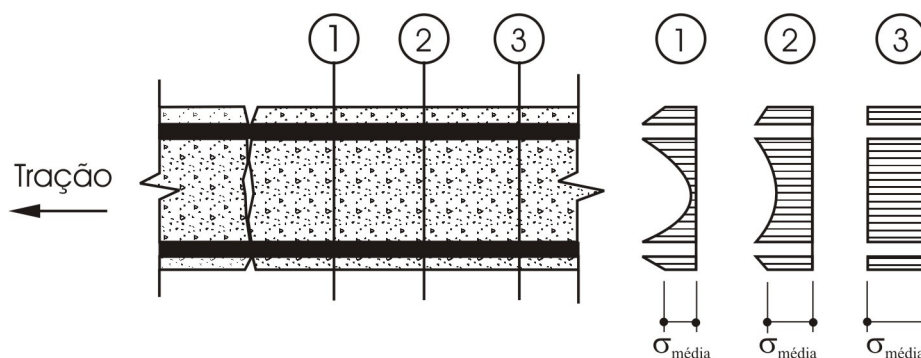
Distribuição de tensões na massa de concreto fissurado (Proença 1988).
